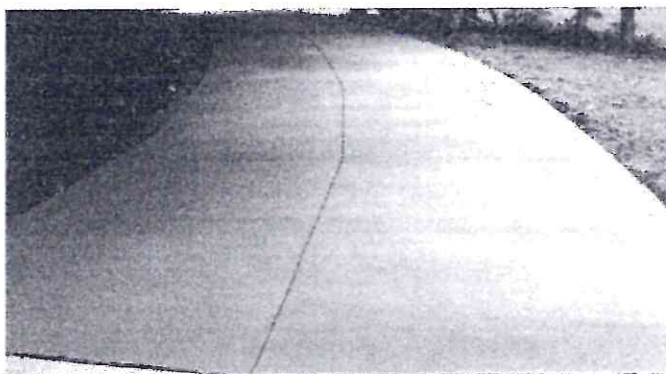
Piso em concreto desempenado com juntas de dilatação em madeira. Fonte: <https://www.fazfacil.com.br/reforma-construcao/calçada-de-cimento/>.
